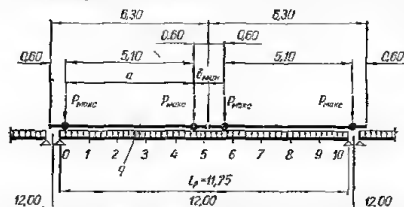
Расчетная схема балки и схема вертикальных нагрузок.
